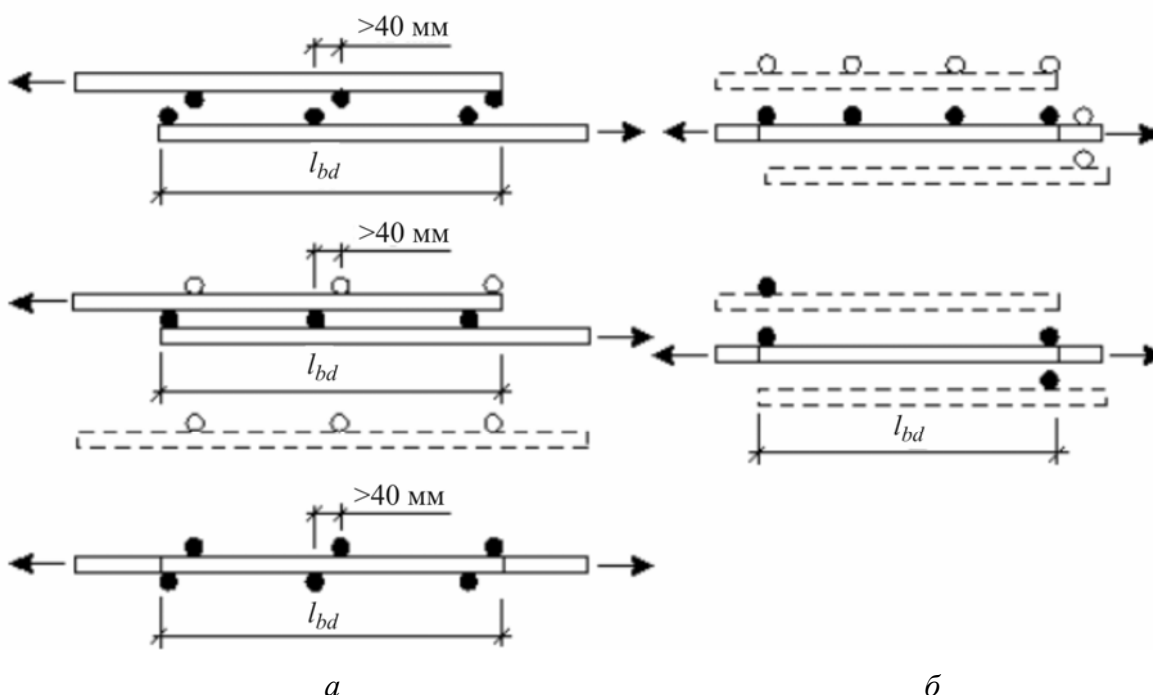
Схема соединения арматурных сеток без сварки в направлении рабочей арматуры: а — из гладких стержней; б — из рифленых стержней
